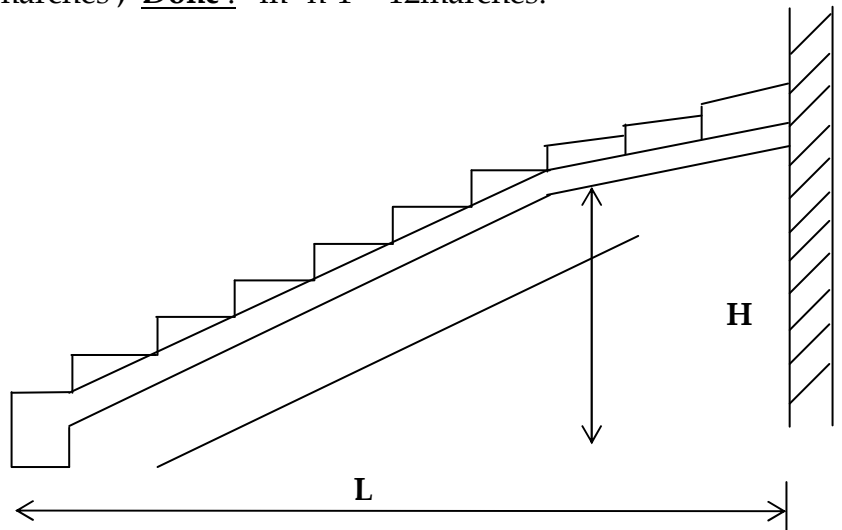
Coupe verticale sur les escaliers balancés
